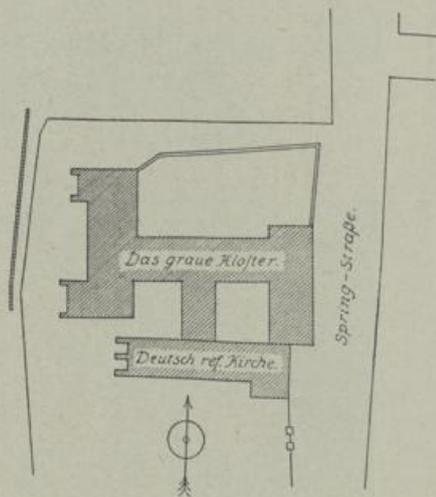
Prenzlau. Franziskanerkloster. Lageplan (nach einem älteren Plane im Stadtarchiv).
